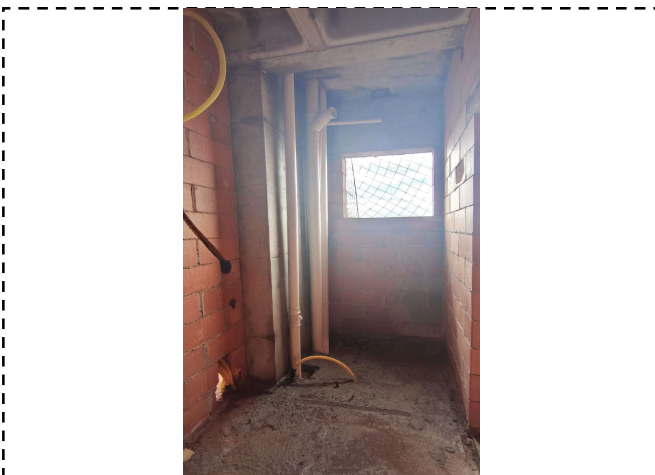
Execução das Prumadas de esgoto e Água Pluviais.
